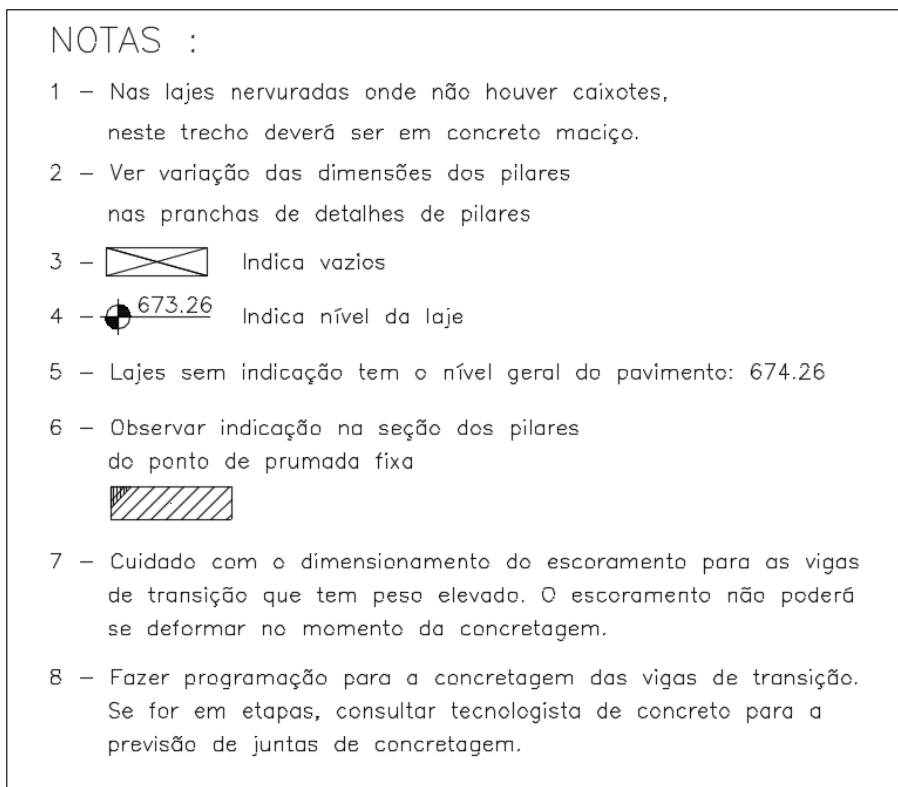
Detalhes do projeto de fôrmas: convenção de pilares.
